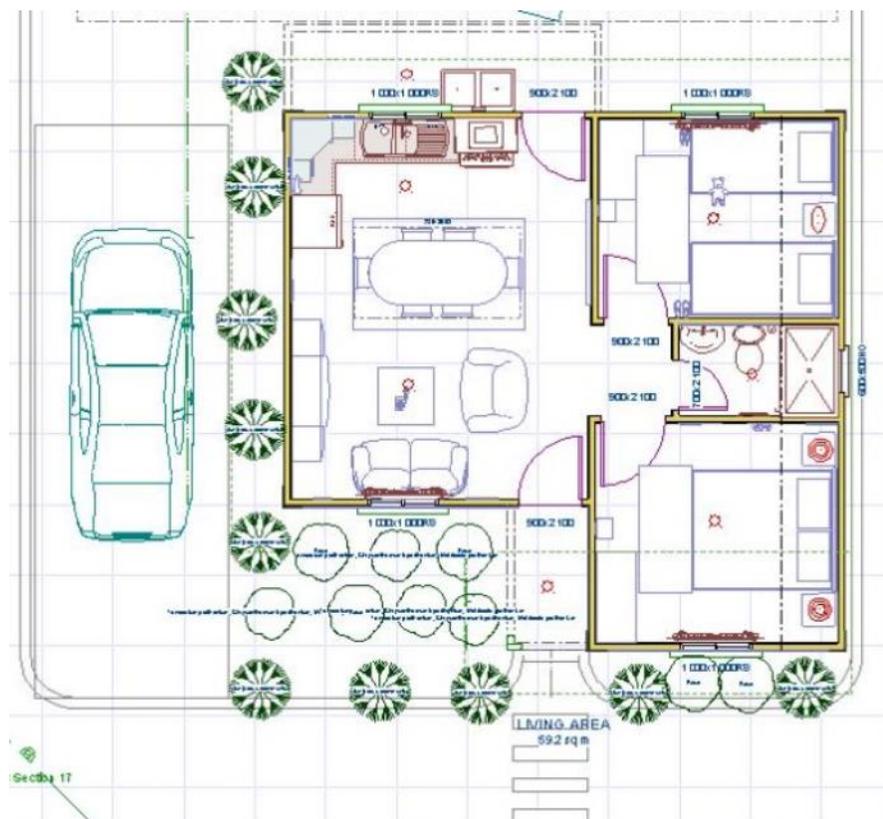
Planta Arquitectónica de Diseño de Vivienda Propuesta.
